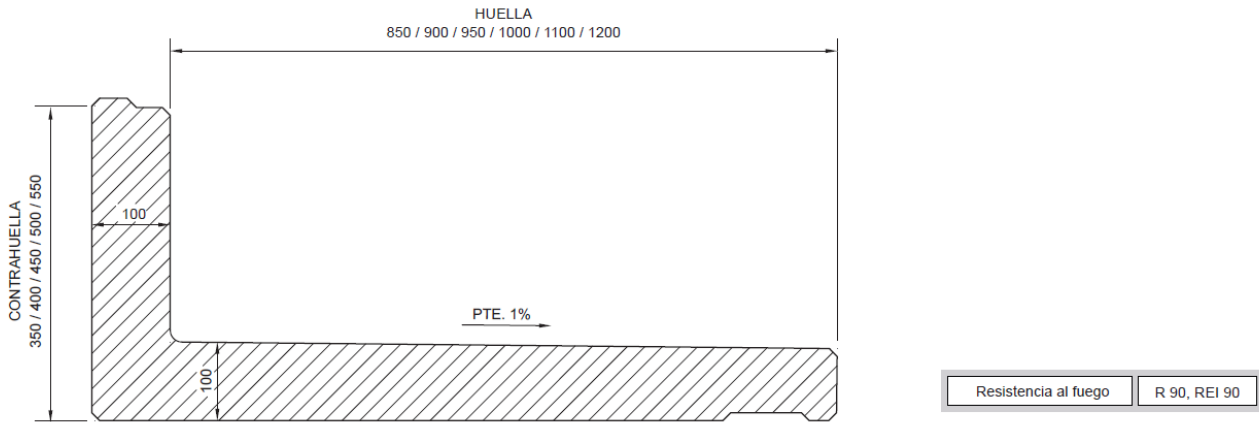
Sección tipo de grada prefabricada de hormigón armado. Fuente: Catálogo de elementos prefabricados de la empresa RIPHORSA S.A
